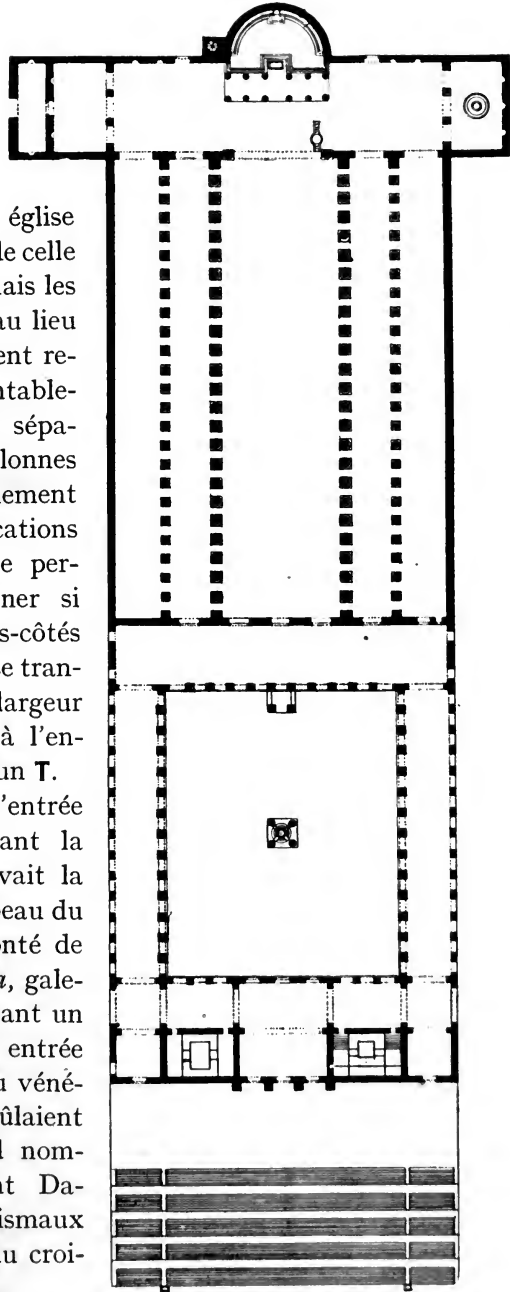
PLAN PRIMITIF DE LA BASILIQUE DE SAINT-PIERRE AU VATICAN.
